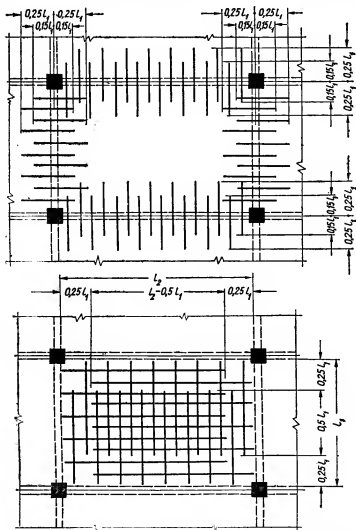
61. Схема армирования плиты, опертой по контуру. План верхней и нижней арматуры.
